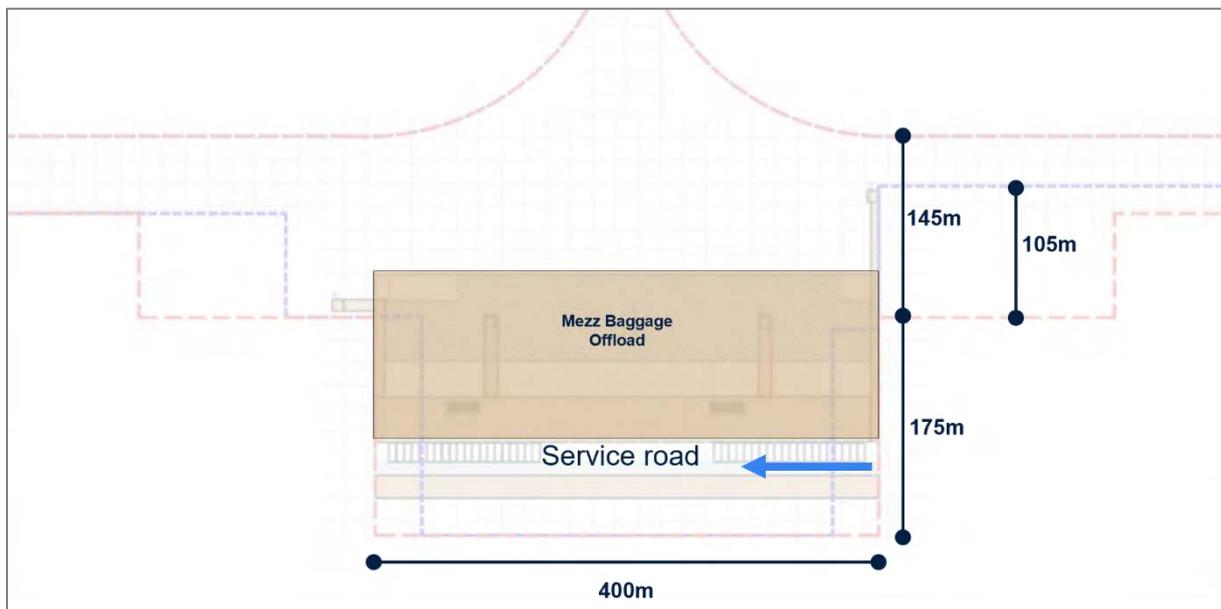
Conceito de disposição do terminal (2082) – Piso subterrâneo (-7m).
